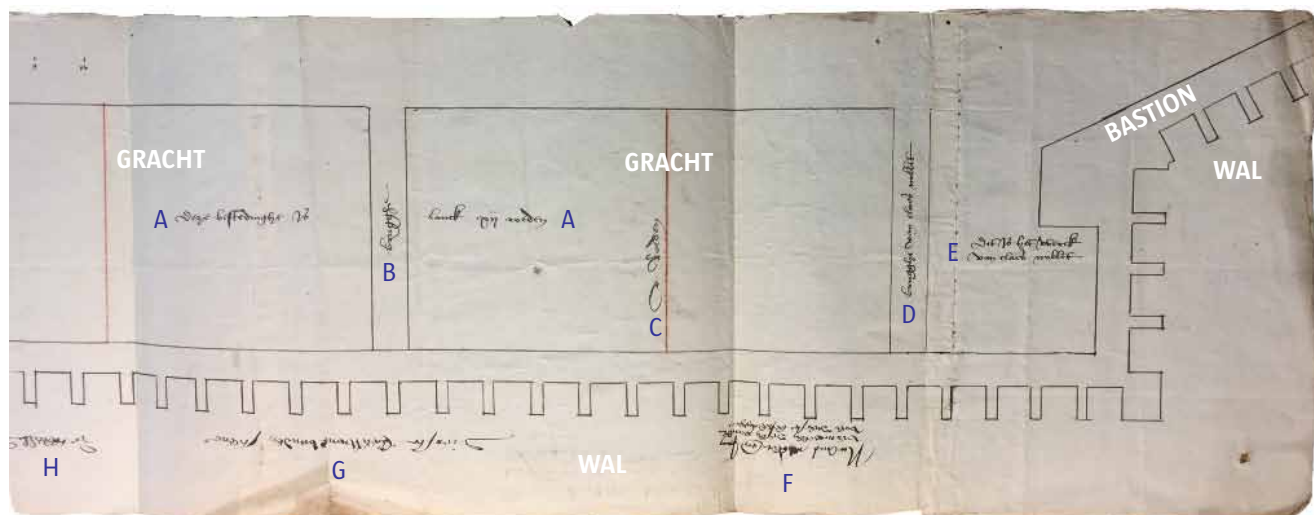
Zestiende-eeuws plan bij de aanbesteding van het uitgraven van de vesten tussen Kipdorppoort en het bolwerk aan de Huidevetterstoren (SAA, PK # 2242, stuk 96)
